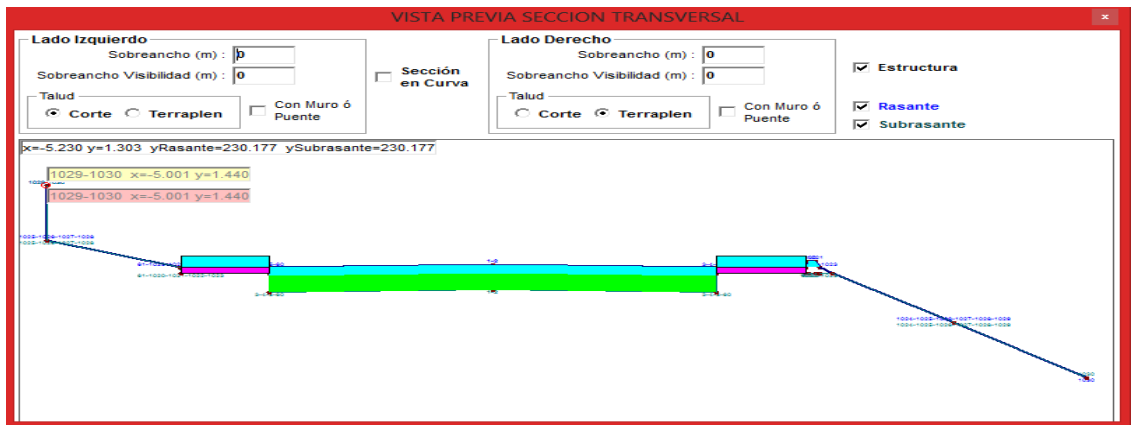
Vista preliminar sección transversal 8 de la vía interna1 entre abscisas 0-15 (m)
